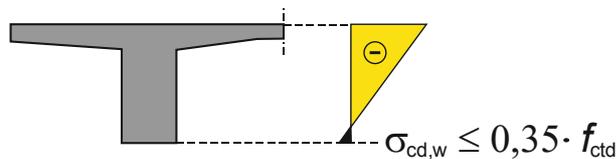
Querschnittsbereiche ohne in der Zugzone liegendem Gurt
